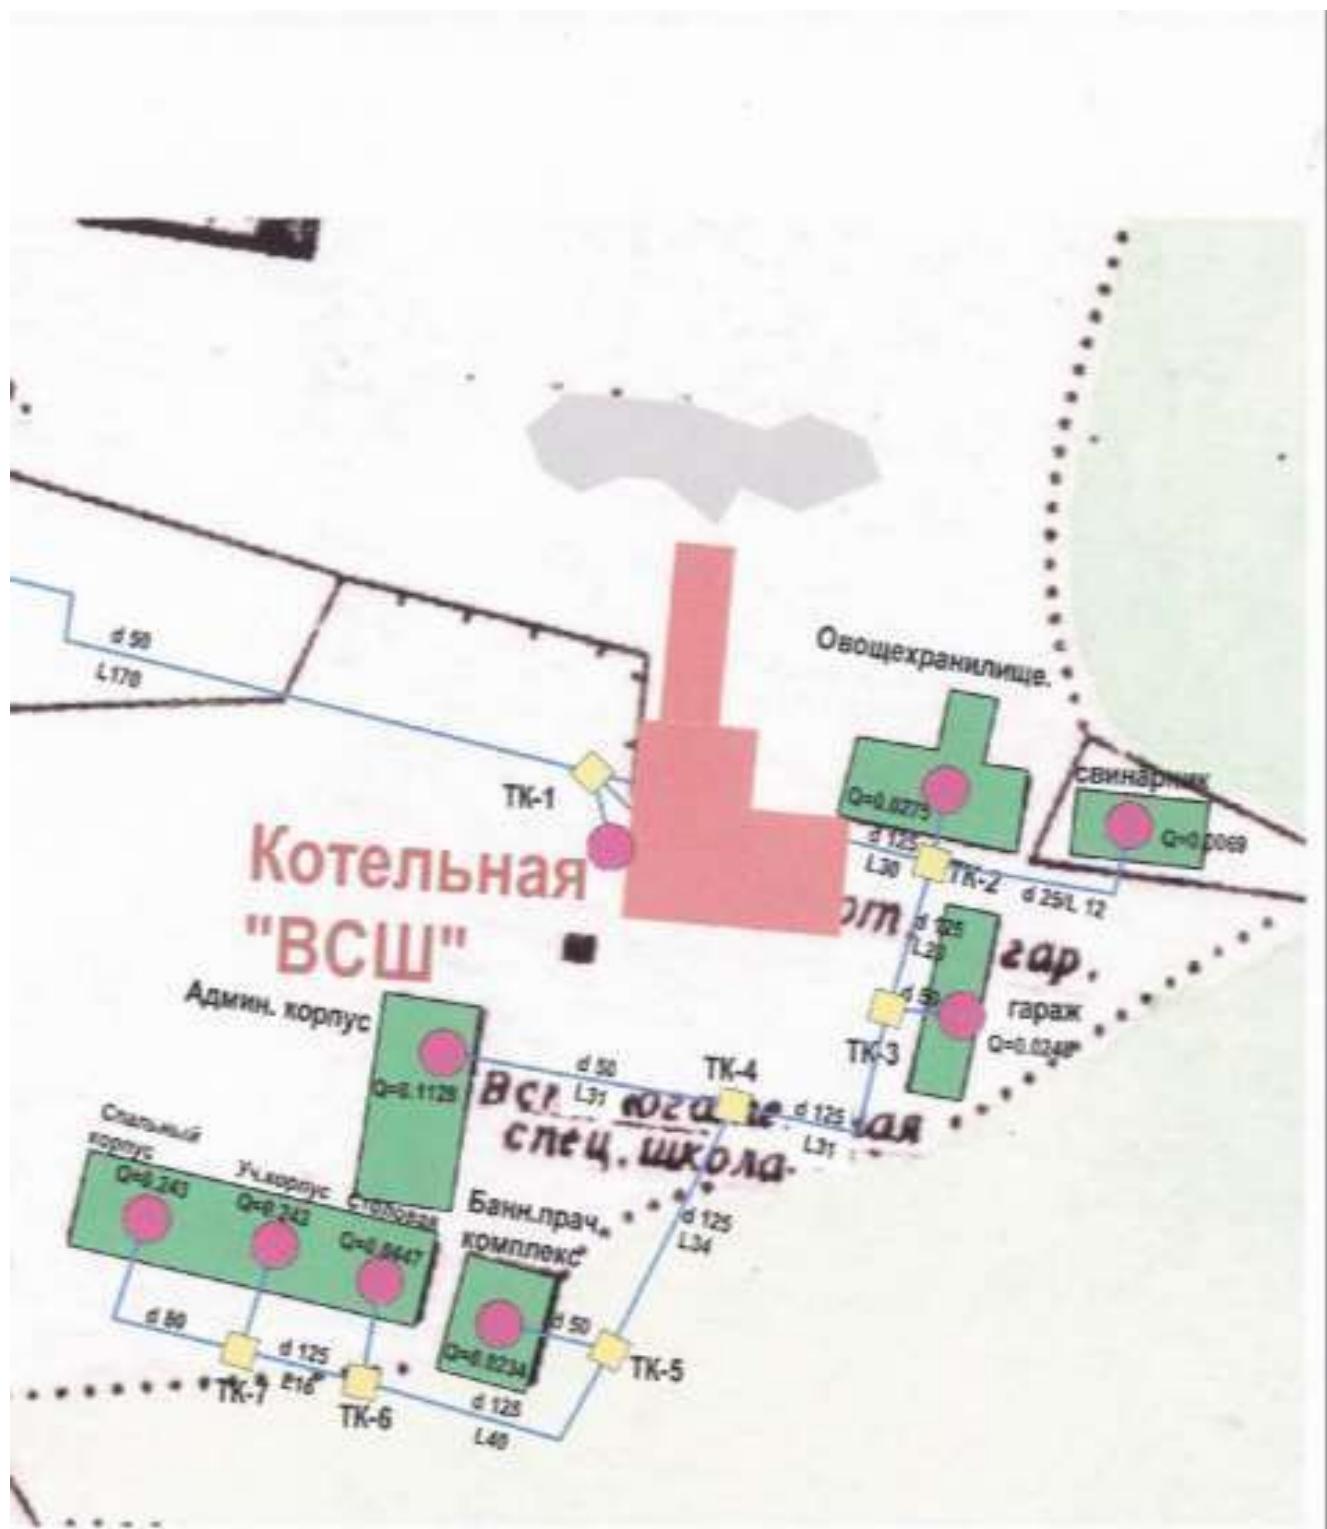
Схема зоны теплоснабжения от котельной ВСШ
